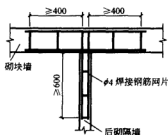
砌块墙与后砌隔墙交接处钢筋网
